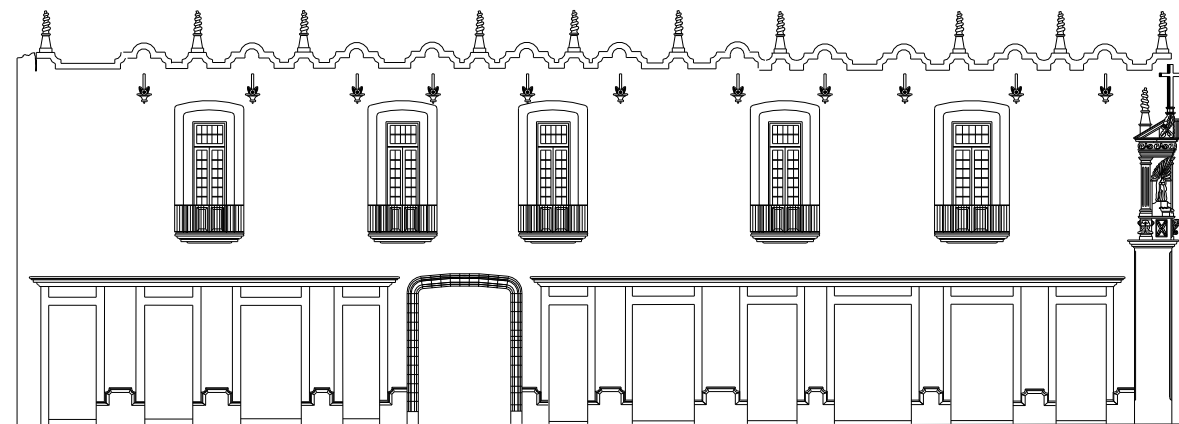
Plano de la fachada sur del Convento de Jesús María según el estado que guardó hasta el año 2000.
